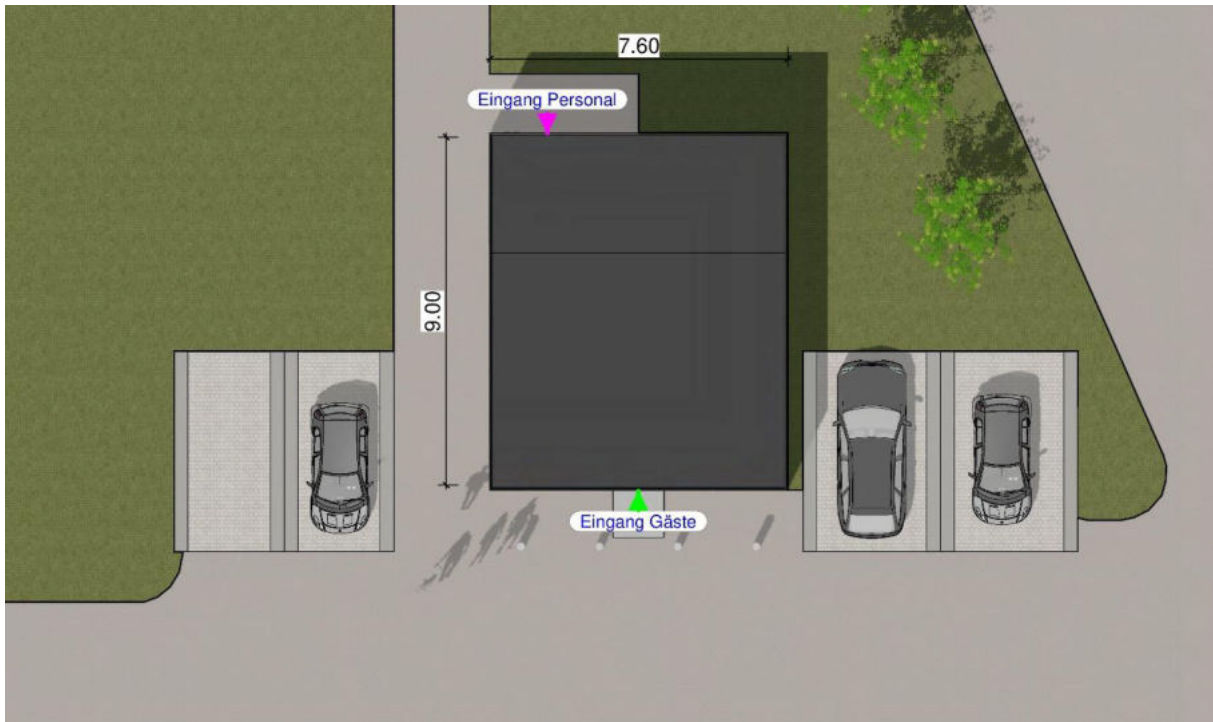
Draufsicht Asia-Imbiss (Ausschnitt), Stand 08.01.2024
